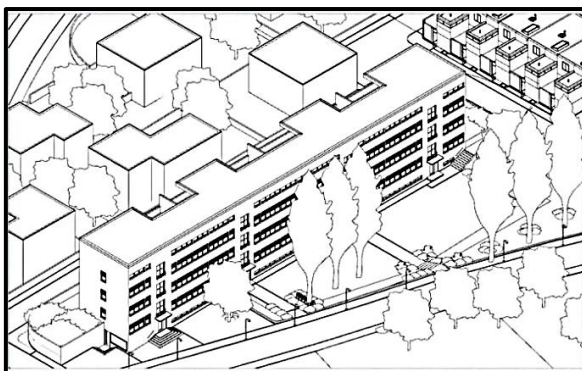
Habitat collectif en barre – Weissenhof – Stuttgart.
